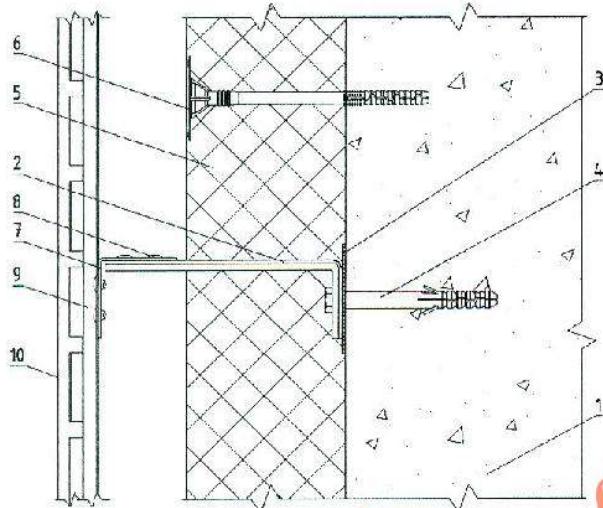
Вертикальный разрез фасадной системы “АЛЬТ-ФАСАД-10”
